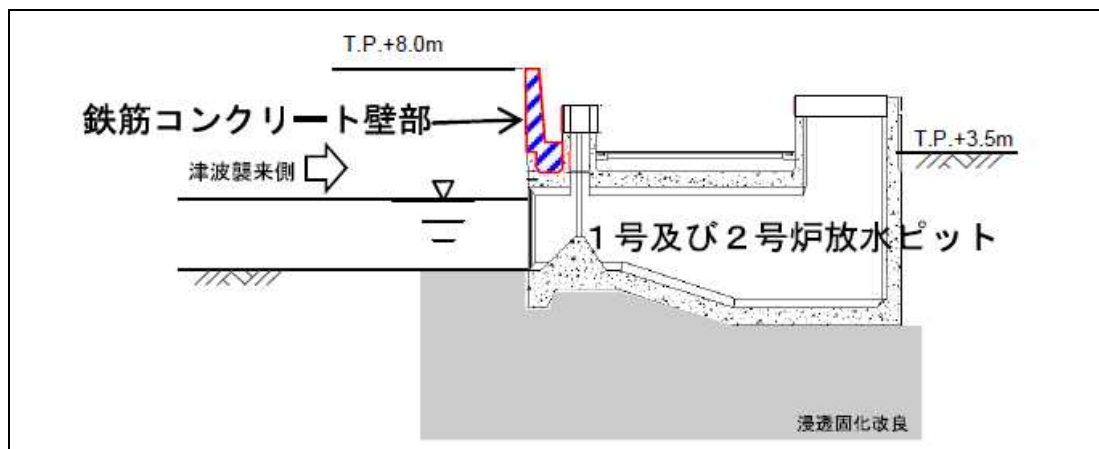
鉄筋コンクリート壁図概要図 (関西電力 高浜 1, 2 号炉)
